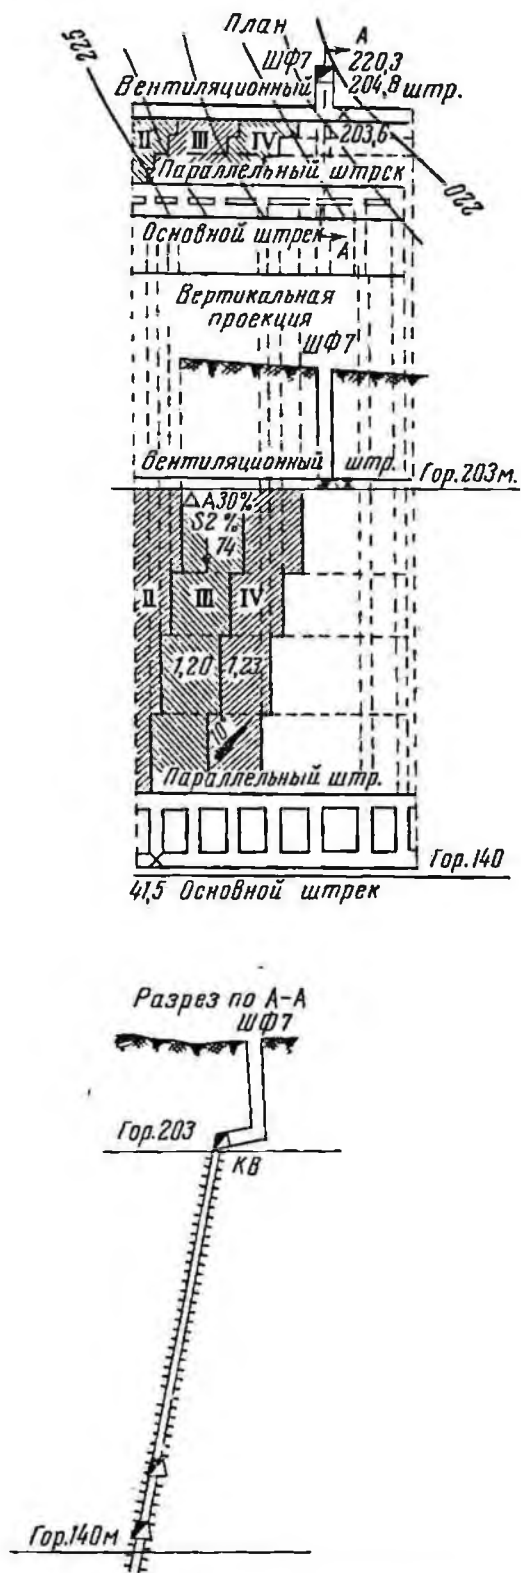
Часть плана горных работ по крутопадающему угольному пласту
